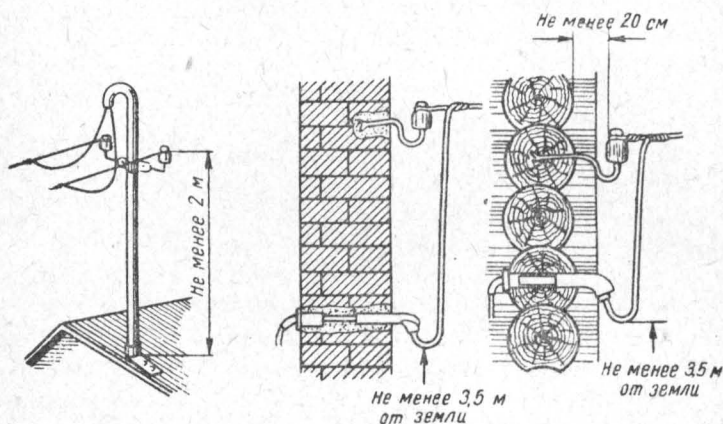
Способы выполнения ввода воздушных проводов внутрь помещения.
